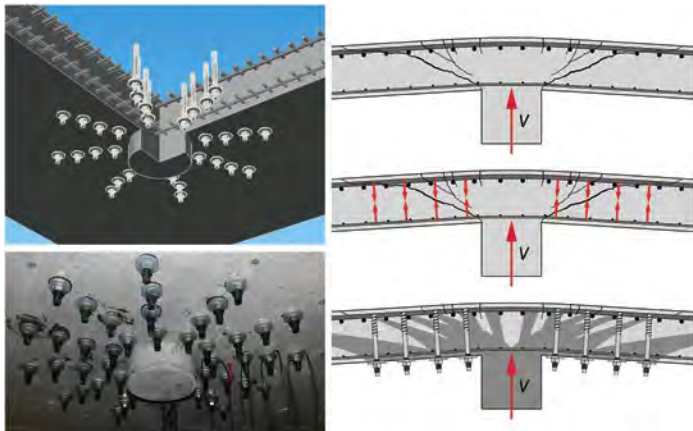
Principe van ponswapening door achteraf aangebrachte betonschroeven
